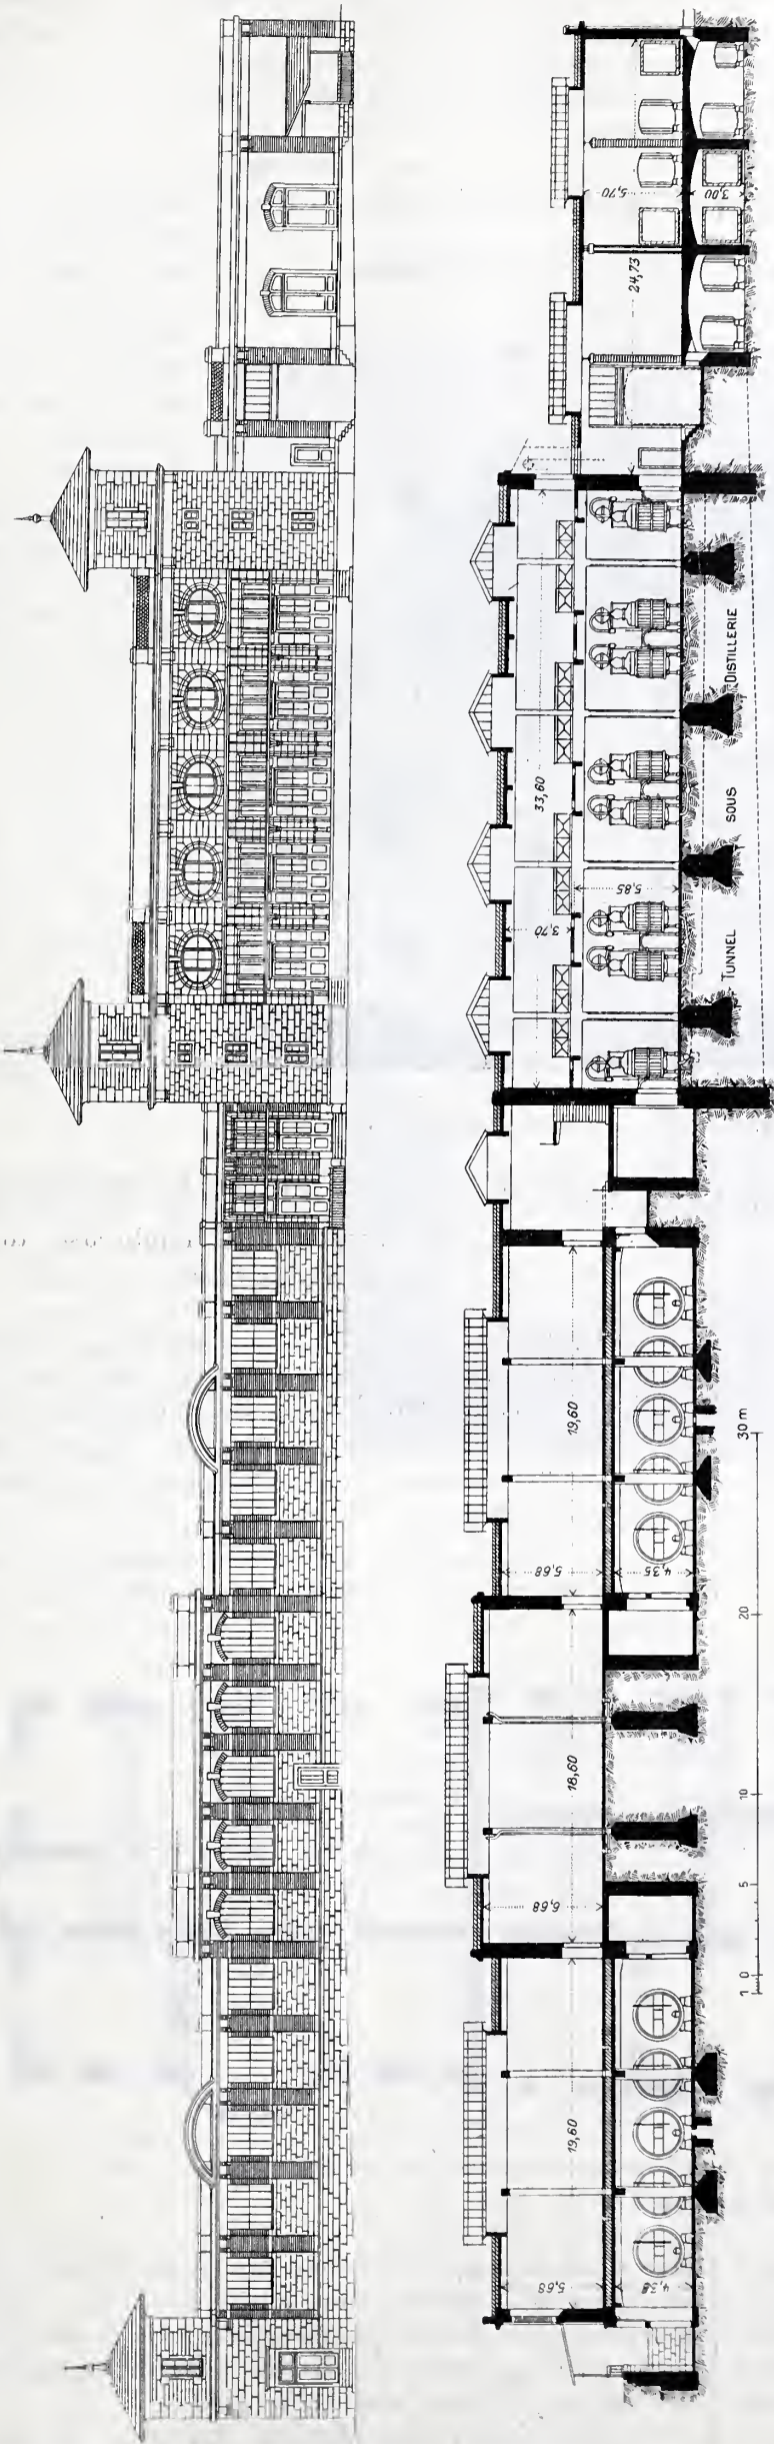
et 7. Façade sud et coupe longitudinale. — Echelle 1 : 500.
